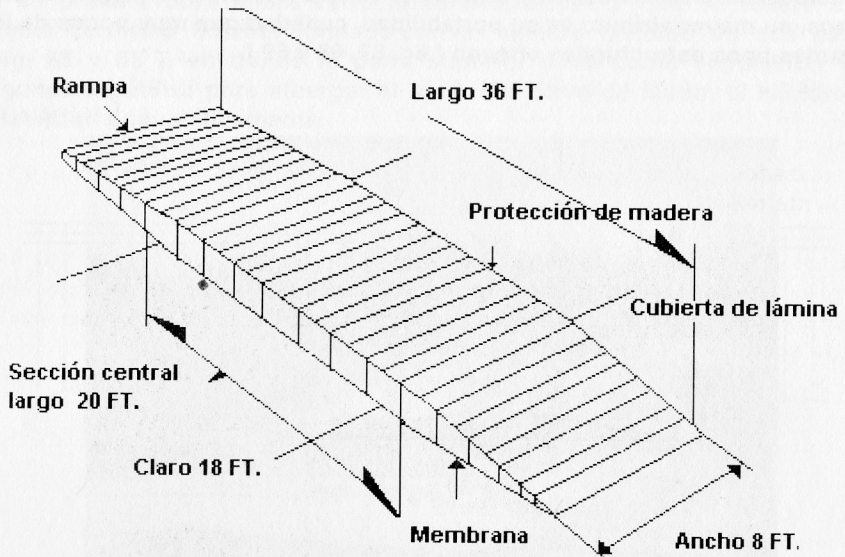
Puente diseñado y fabricado por la milicia inglesa (1965).
